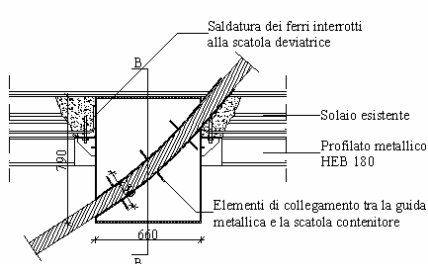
Deviatore tipo e relativo dettaglio d'installazione (sezione B-B di Figura 19 e corrispondente sezione longitudinale)
